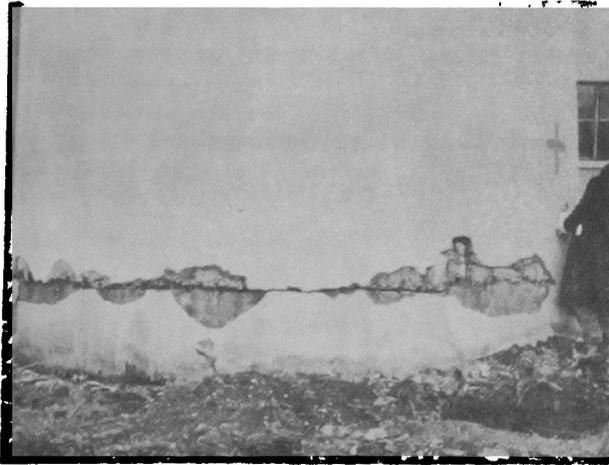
Detalle de daños en la parte opuesta a Fig. 10.
